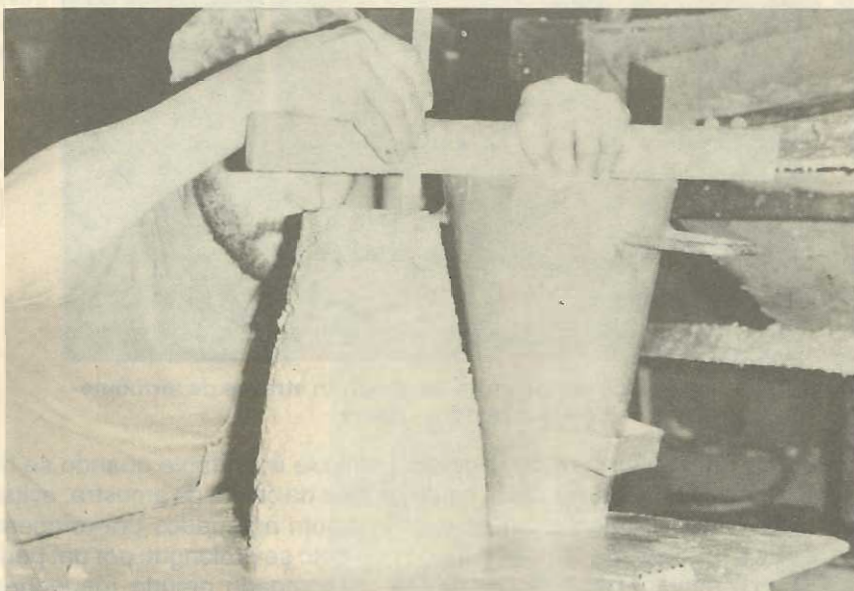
Medição do abatimento do concreto peneirado (passante pela malha de abertura 38 mm). A partir do concreto massa (D Máx. 76 ou 152 mm).
